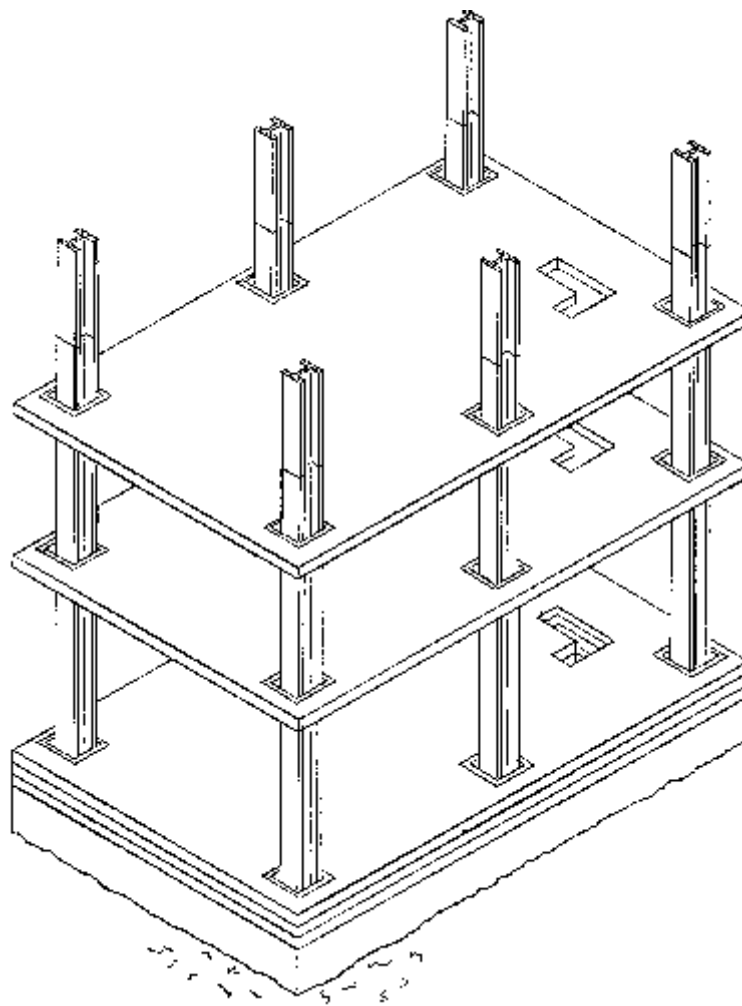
Lift Slab. (www.dictionaryofconstruction.com)
